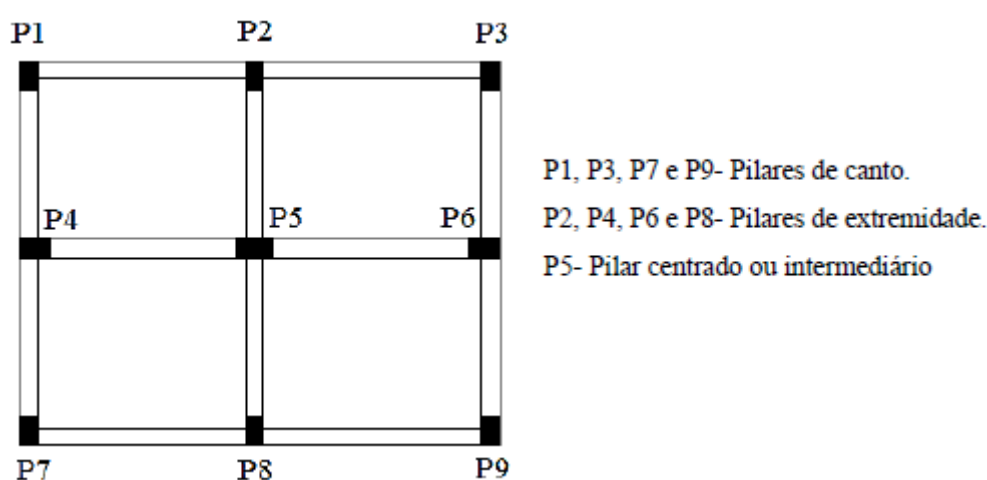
Arranjo de pilares de edificações (FERREIRA, 2014)
